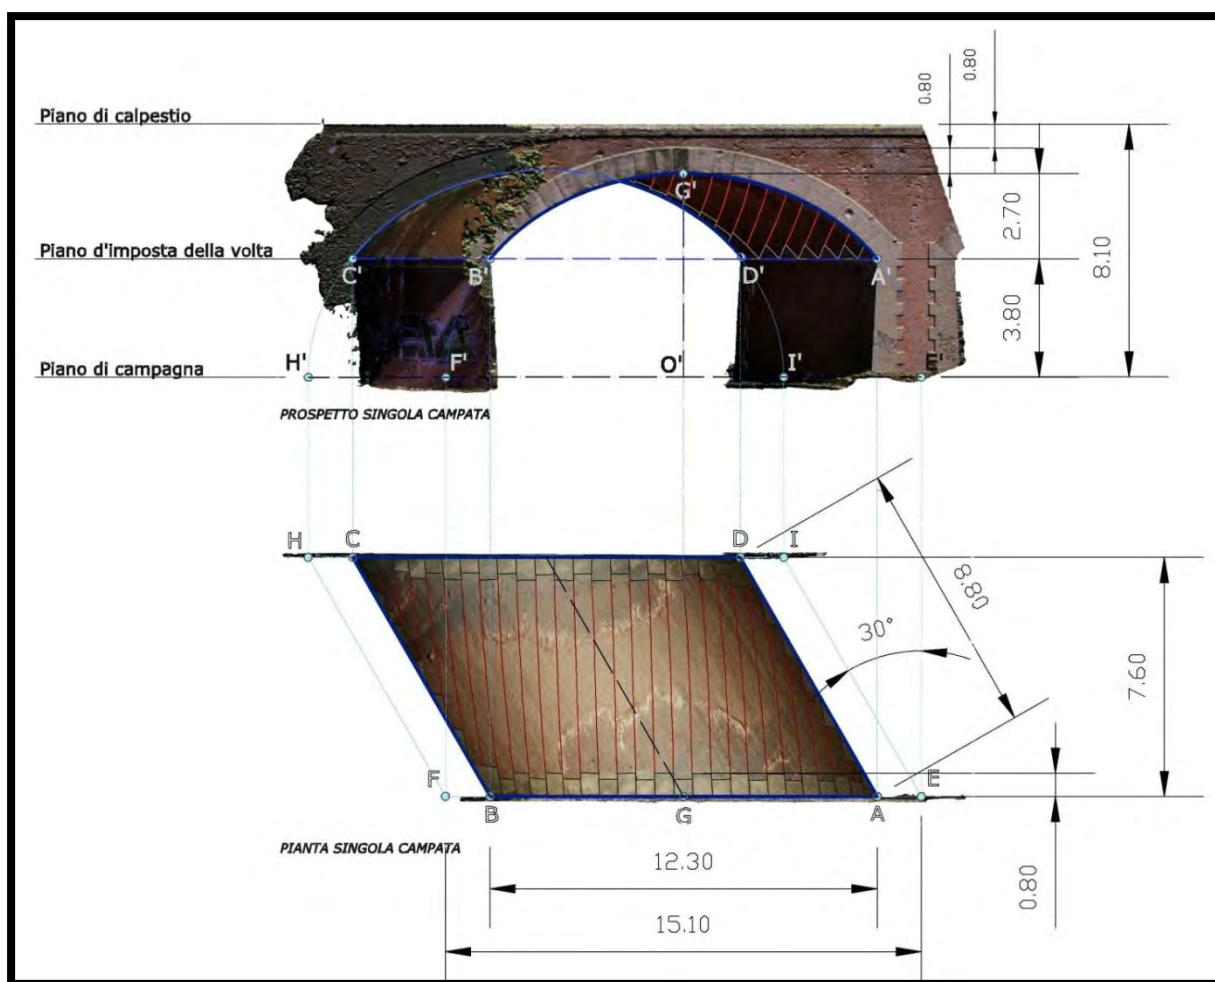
Pianta e Prospetto quotati della singola campata. (Scala 1.:200).
